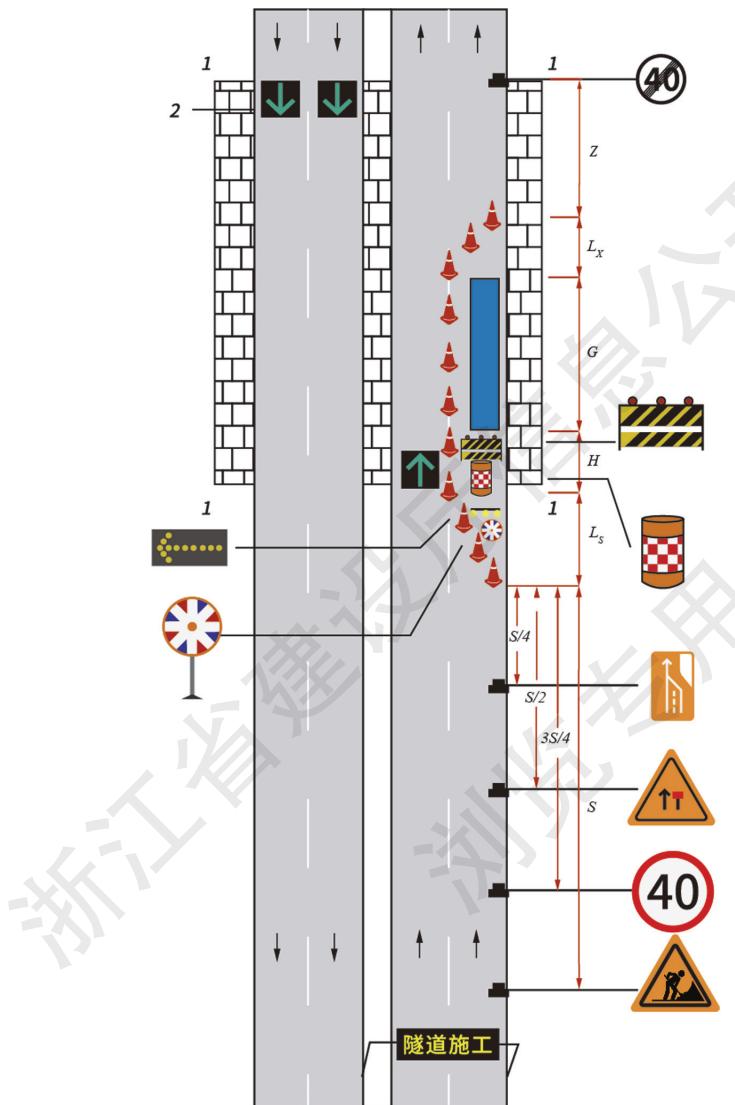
隧道工作区位于洞口时养护作业控制区布置示意
